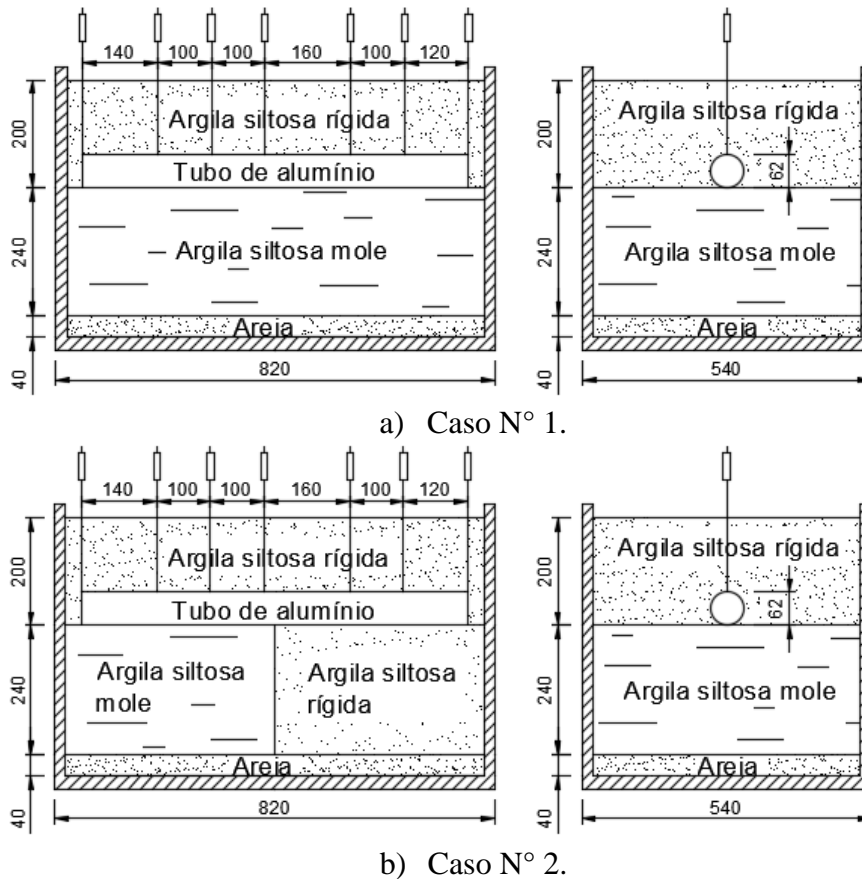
Vista dos modelos ensaiados (Ma *et al.*, 2010)
